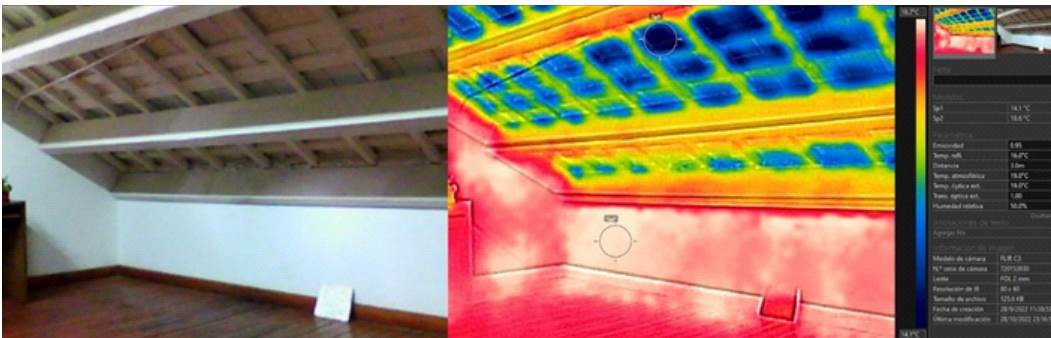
Termografía interior tomada hacia el ángulo nor-oeste de la planta alta.
